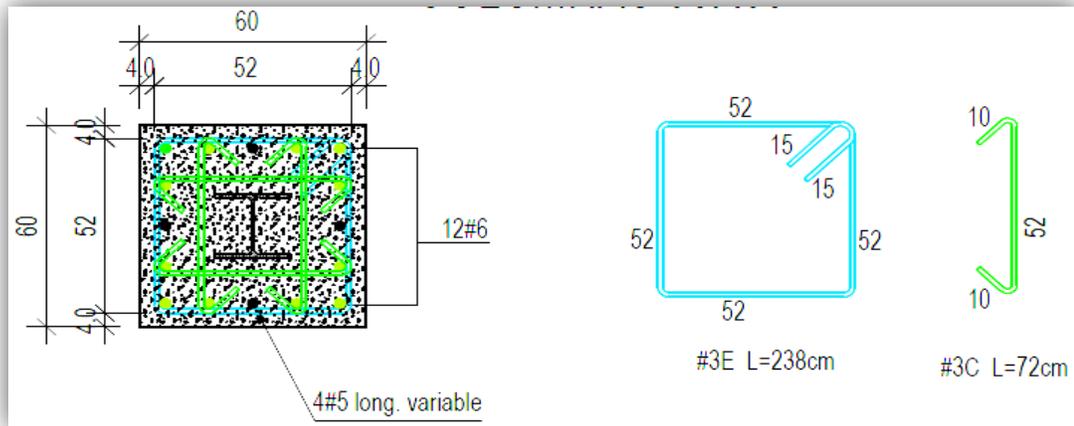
Refuerzo transversal de las columnas de 0.60 m x 0.60 m.
